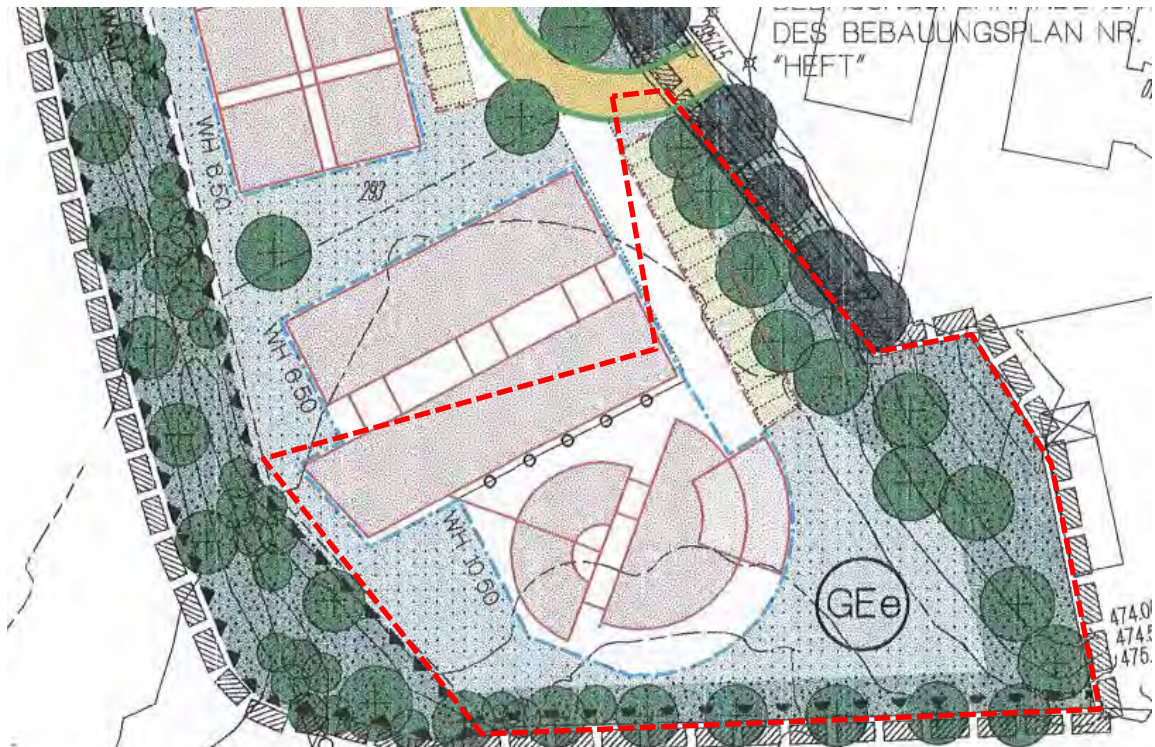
Änderung des Bebauungsplans (Änderungsbereich - rot) - ohne Maßstab!
